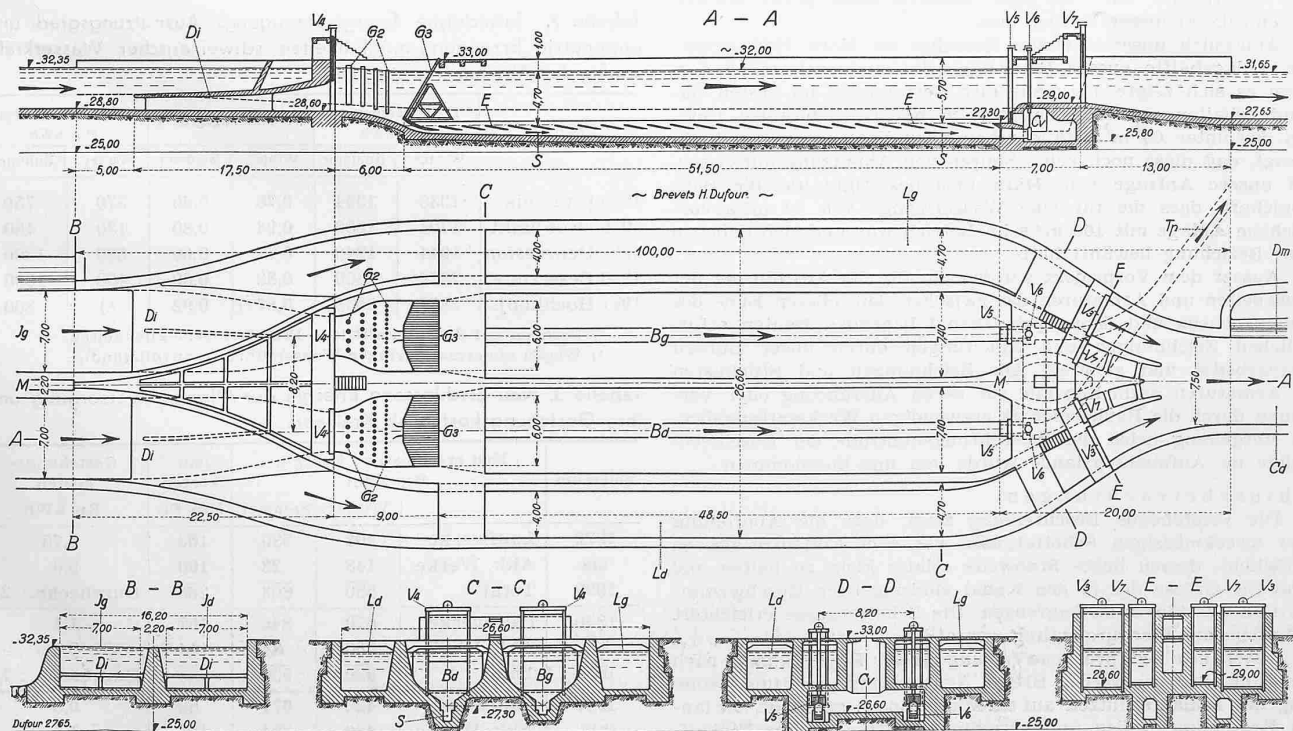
Entsander, Grundriss 1 : 600. Legende im Text
